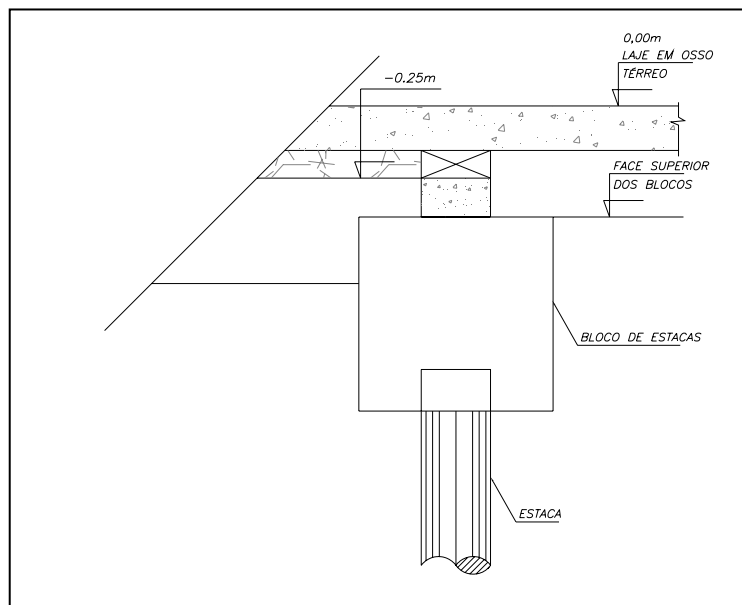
Detalhe de furo na viga para ventilação de gases
